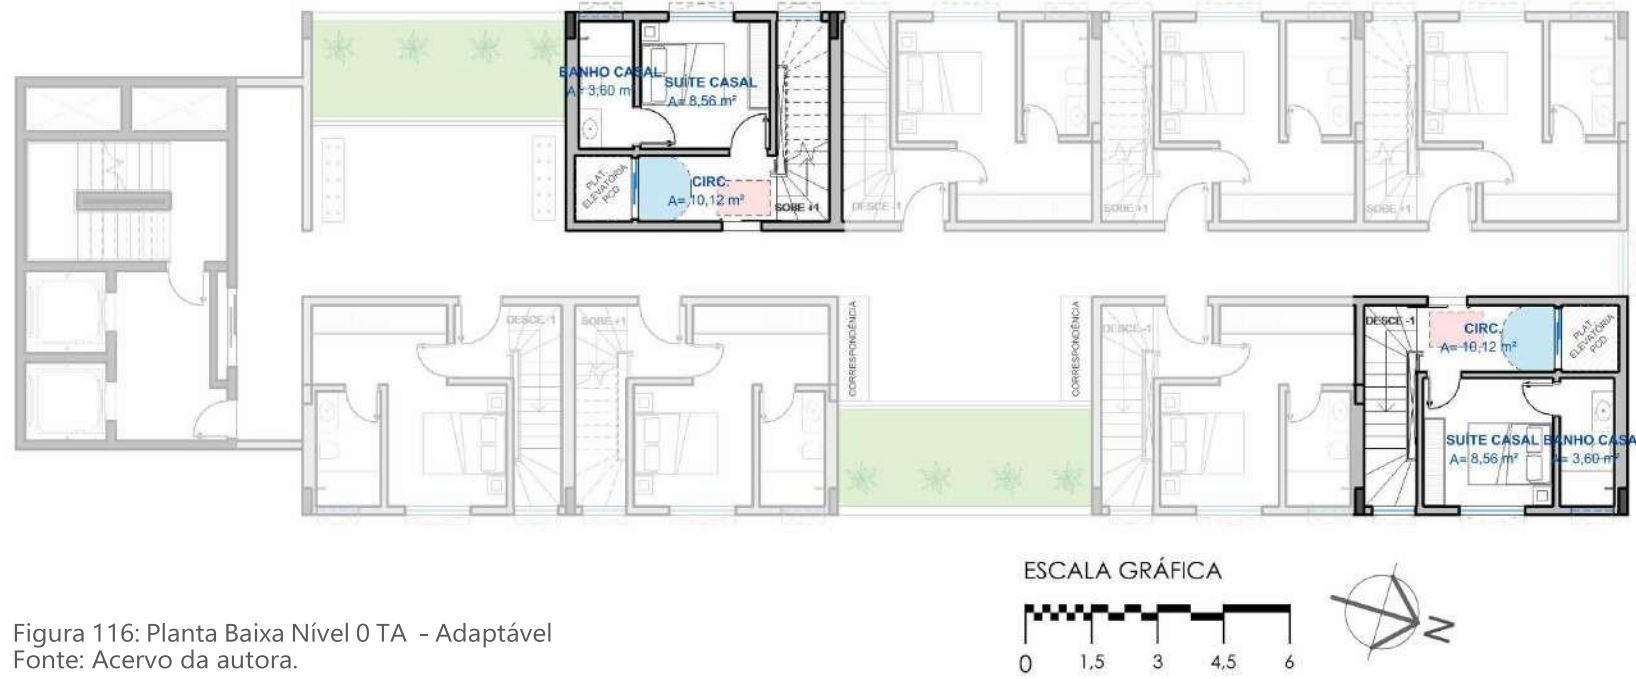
Planta Baixa Nível 0 TA - Adaptável
